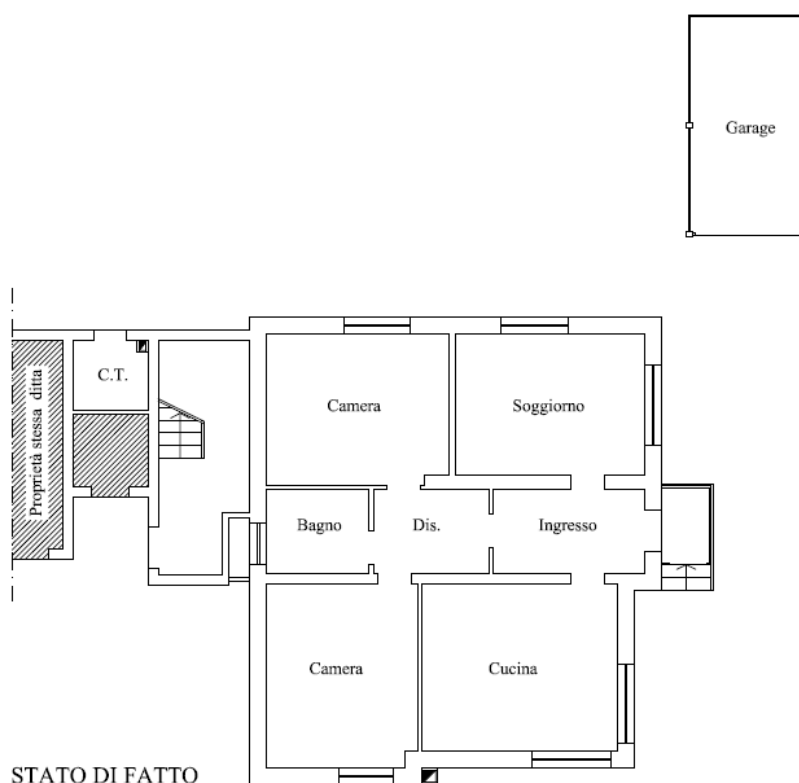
Planimetrie rilievo appartamento e garage piano terra ([Allegato L.03.03](#))
